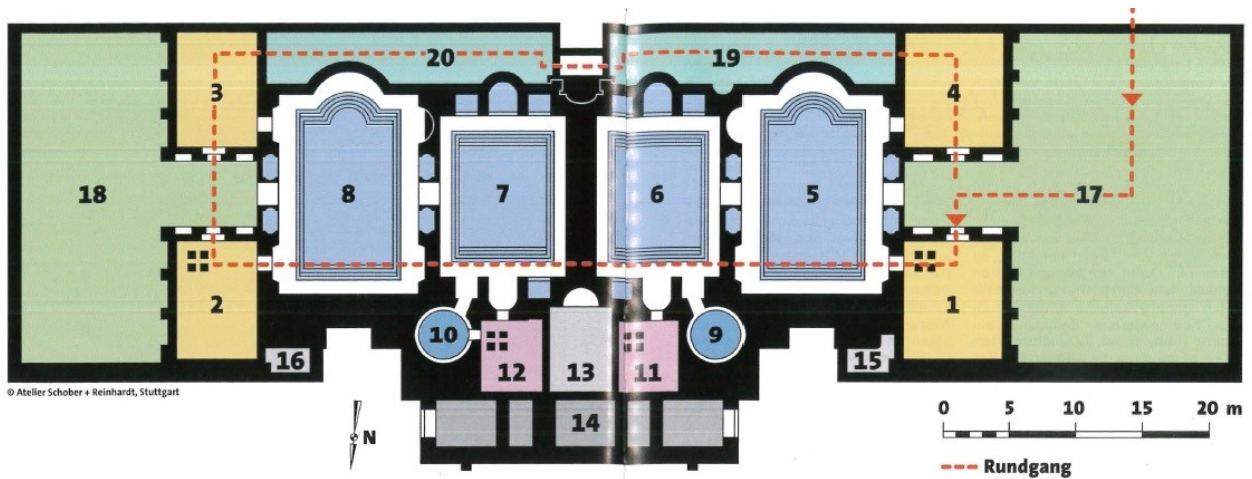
Stabilimento termale, Fase 2. Planimetria. Fonte: Filgis 2002 pp. 58-59 fig. 36.
